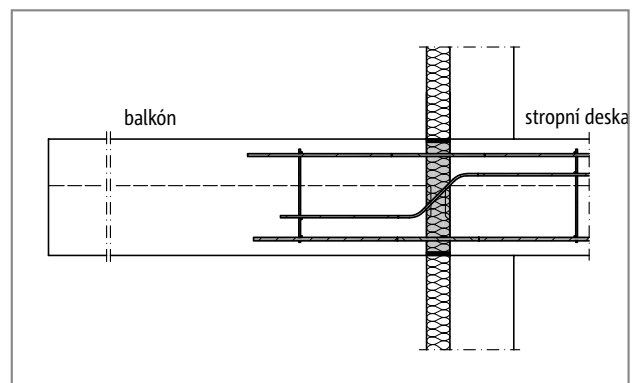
Schöck Isokorb® T typ B: Balkónová konstrukce s volně vyloženými průvlaky (prefabrikovaný balkón)
